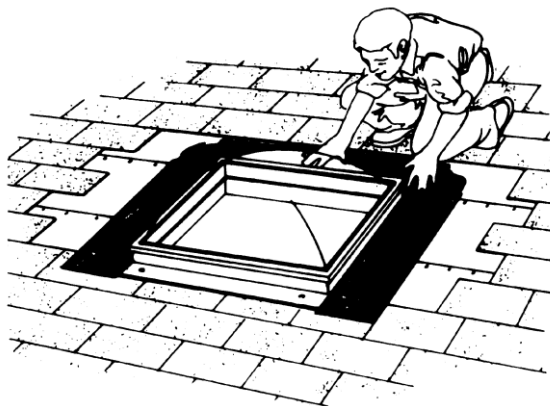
Укладка рубероида, толя или кровельного картона (Novi)
